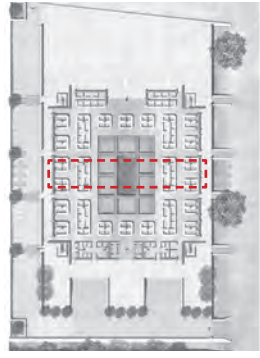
PLANTA ALTA ISOMÉTRICO.
